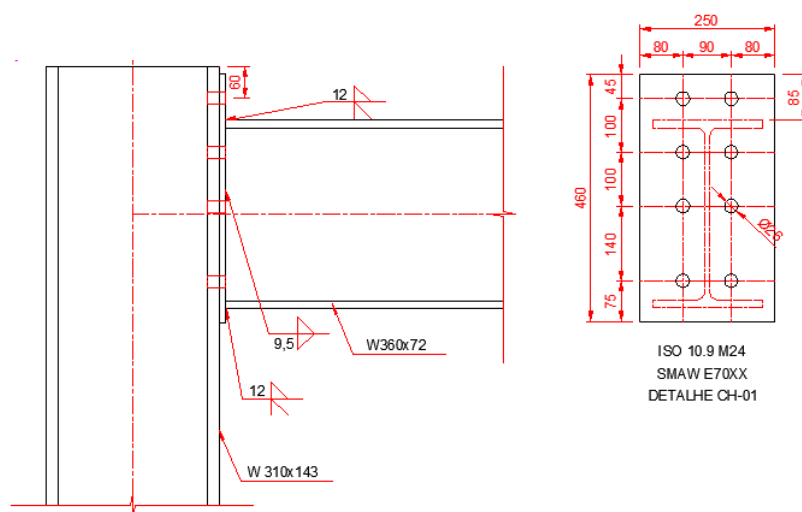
Ligação viga pilar de extremidade W360x72-W310x14 (dimensões em mm).
